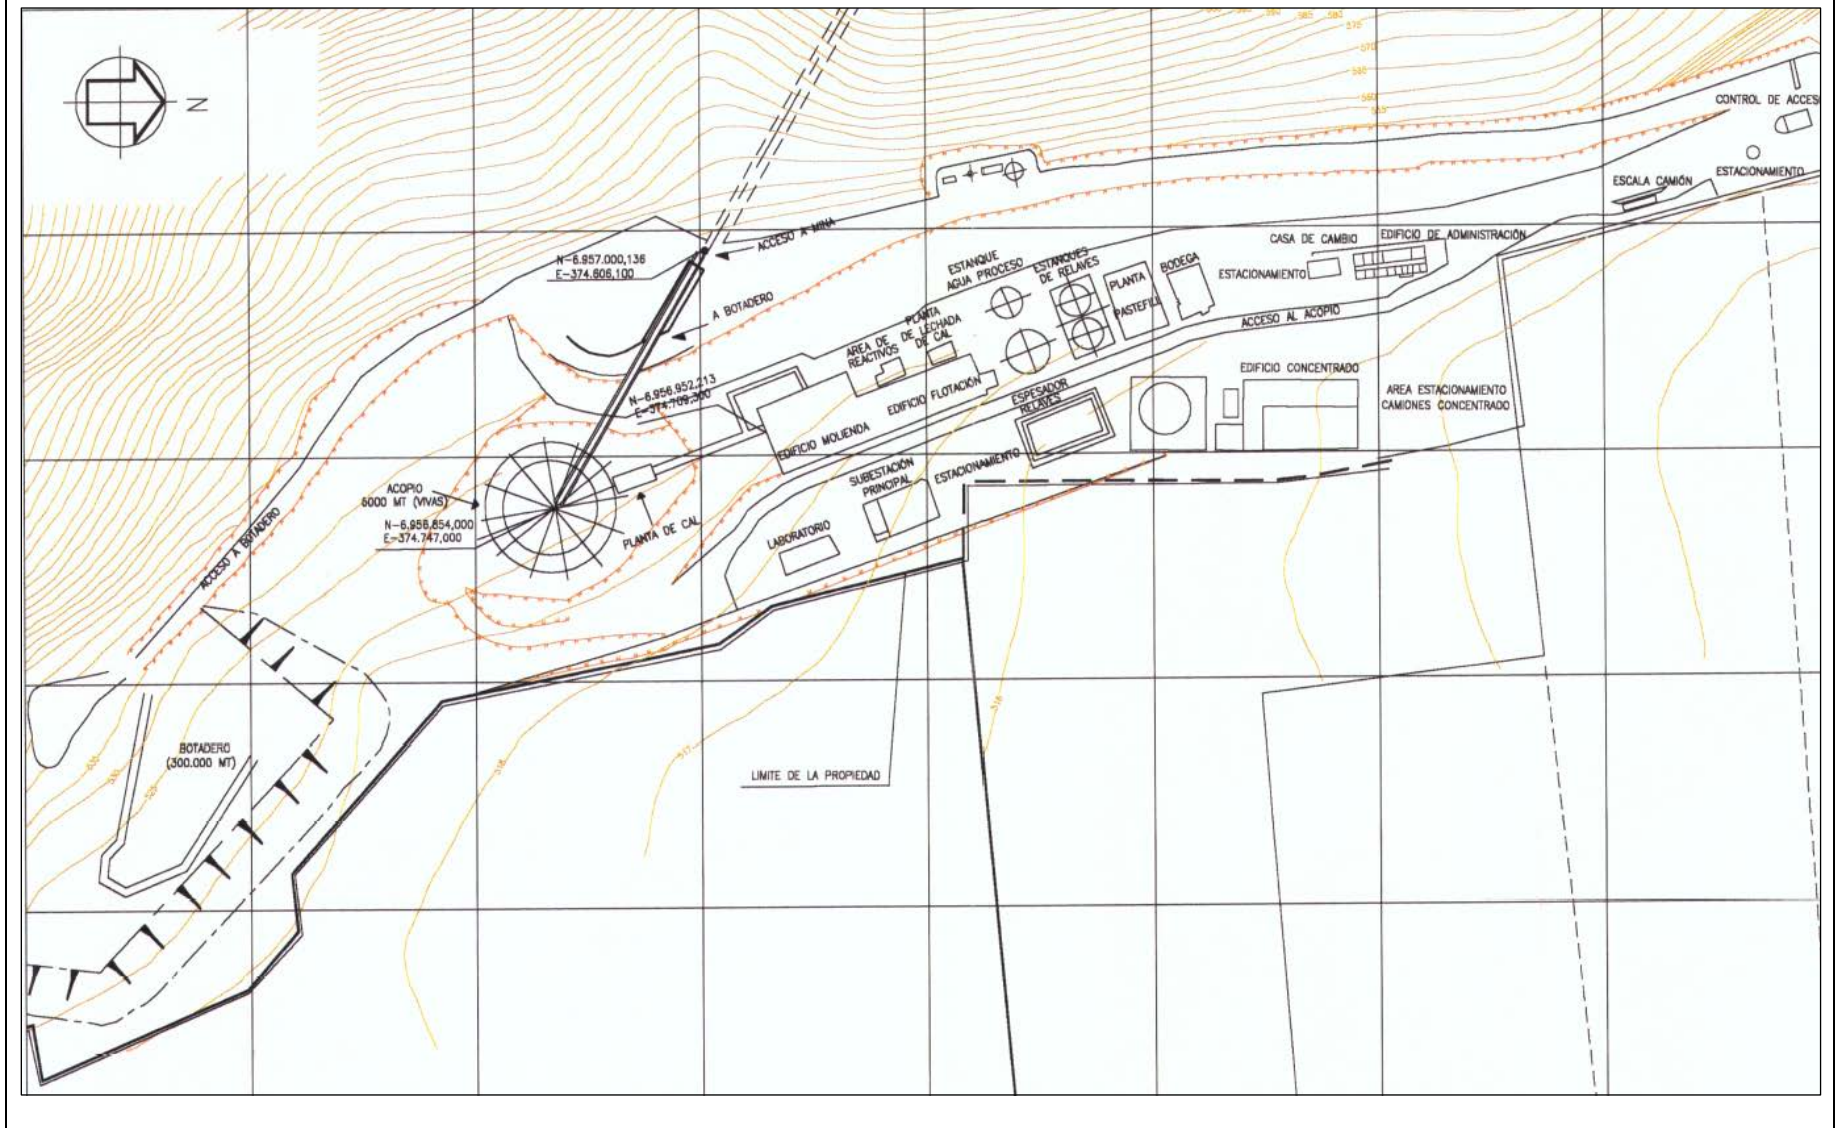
Layout del proyecto.- Relaveducto (Fuente: Modificación Trazado Tramo Relaveducto).
